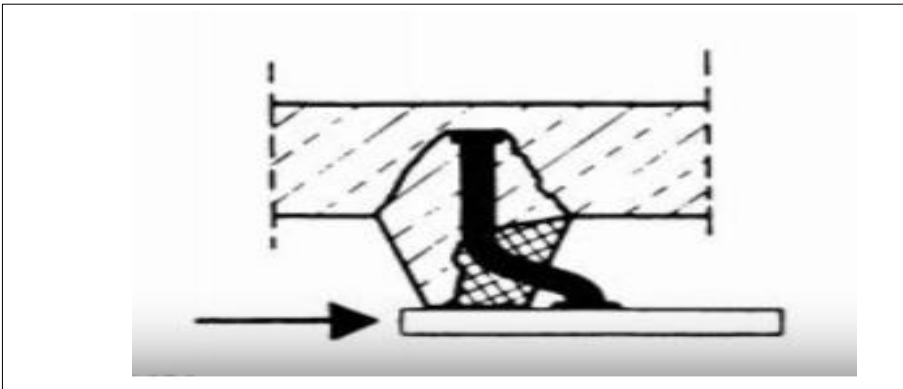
Fisuración del nervio [hermigónconcreto](#). Fuente: CEN (1992).
